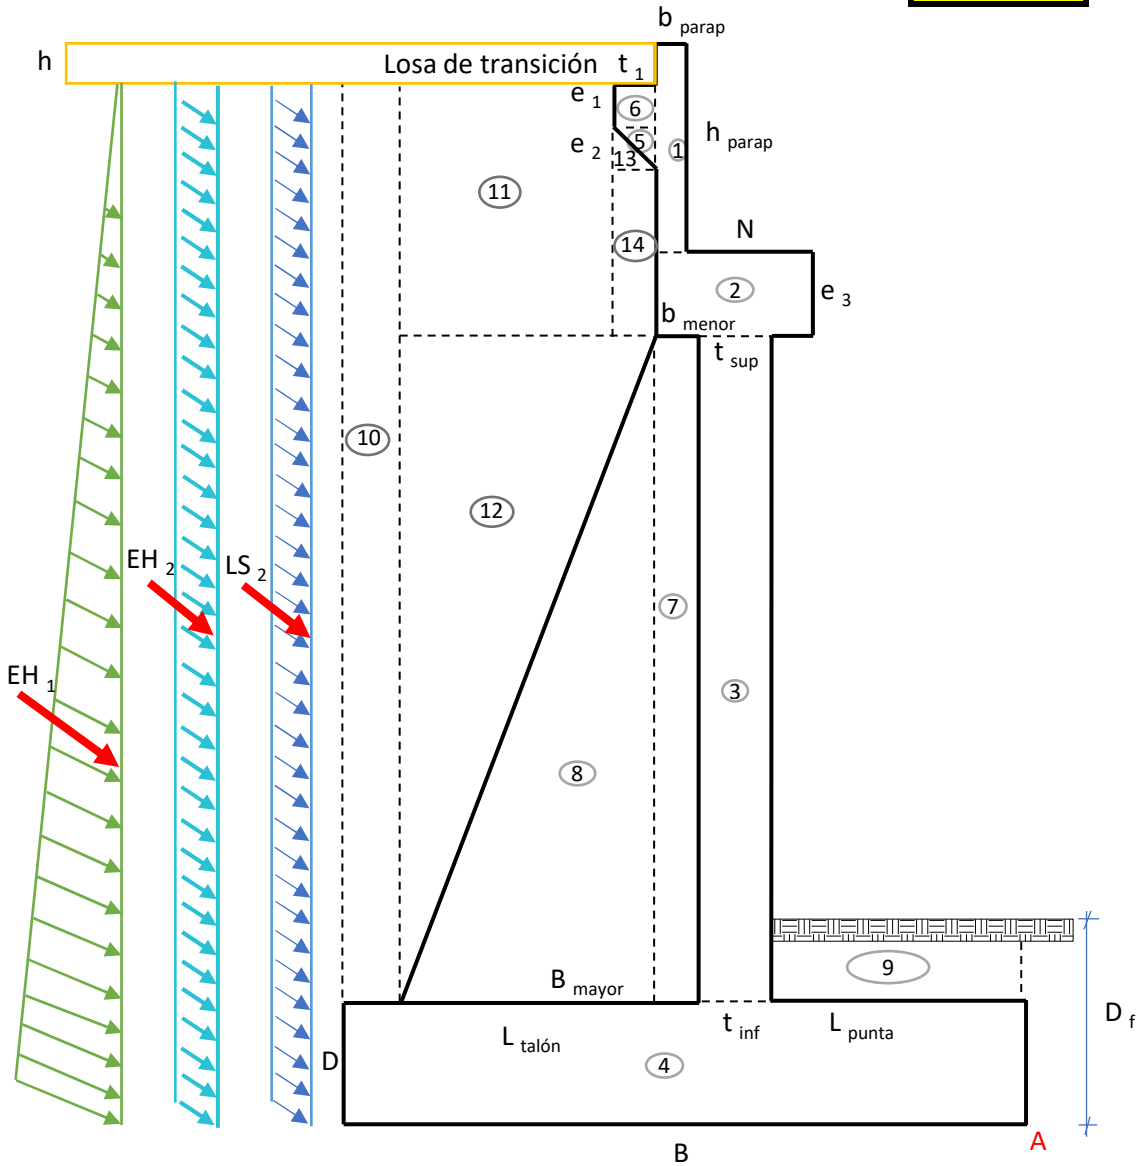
Dimensiones propuestas para el cálculo del estribo.
